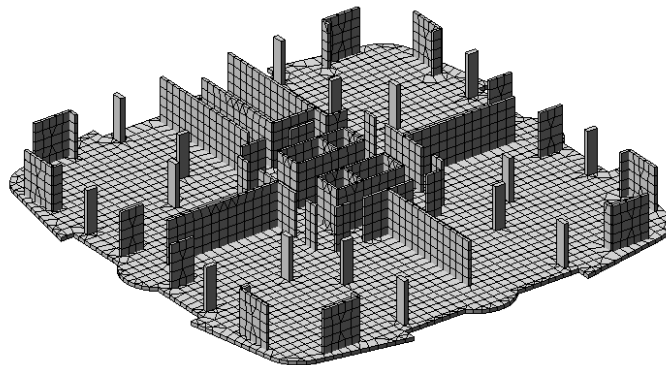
Элемент расчётной схемы здания в САПФИР.
